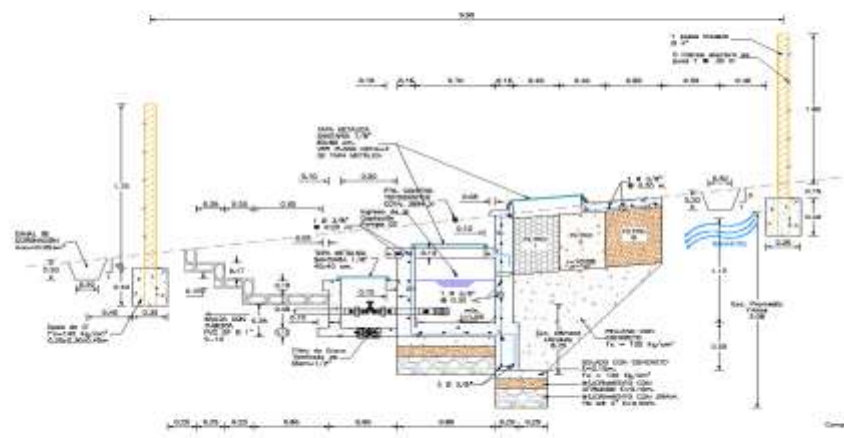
DETALLE C. SECCIÓN LONGITUDINAL DE LA CAPTACIÓN SEGUN FIG. 1.1.
